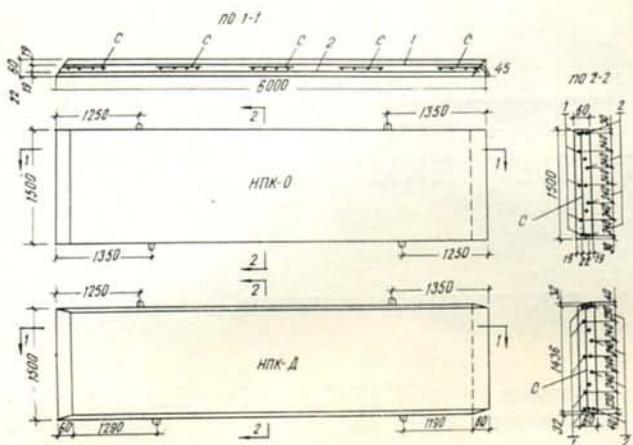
Тонкостенные преднапряженные железобетонные плиты НПК-Д и НПК-О. Планы, продольные и поперечные разрезы. 1,2 — преднапряженная арматура, С — сетка.
